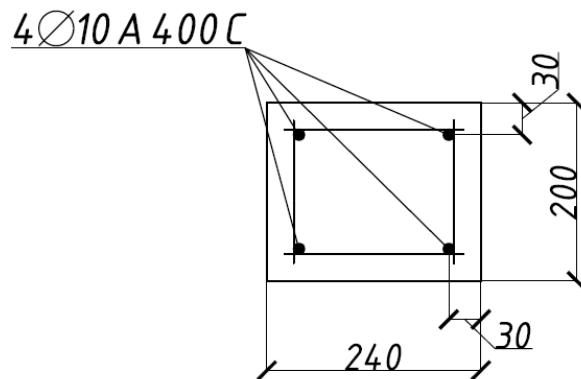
Армування поперечного перерізу верхнього поясу ферми
